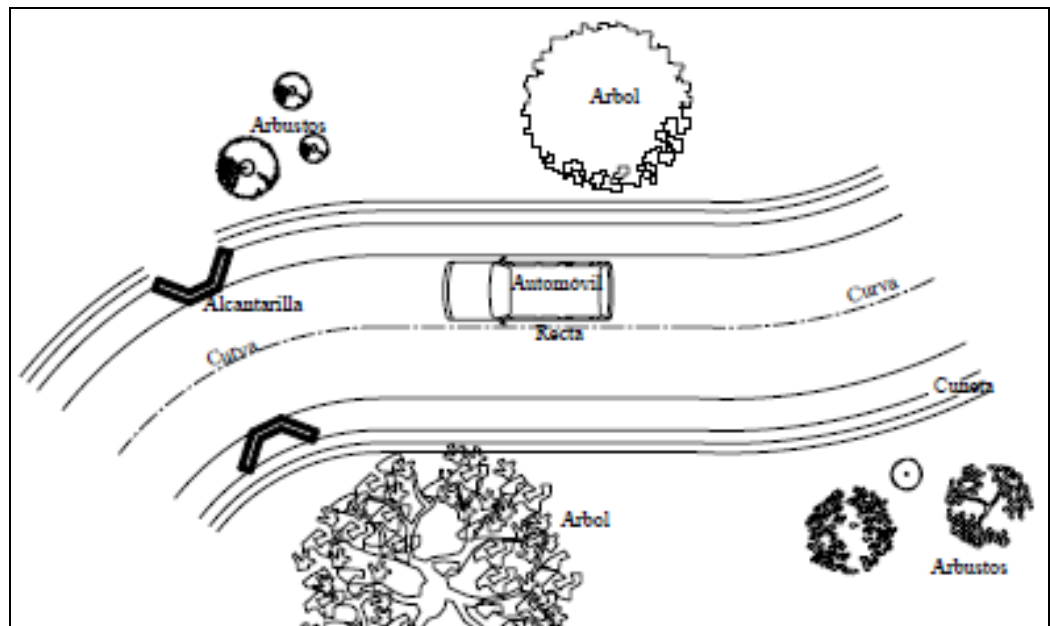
Vista en Planta de un Camino Vecinal tipo IV-E.
